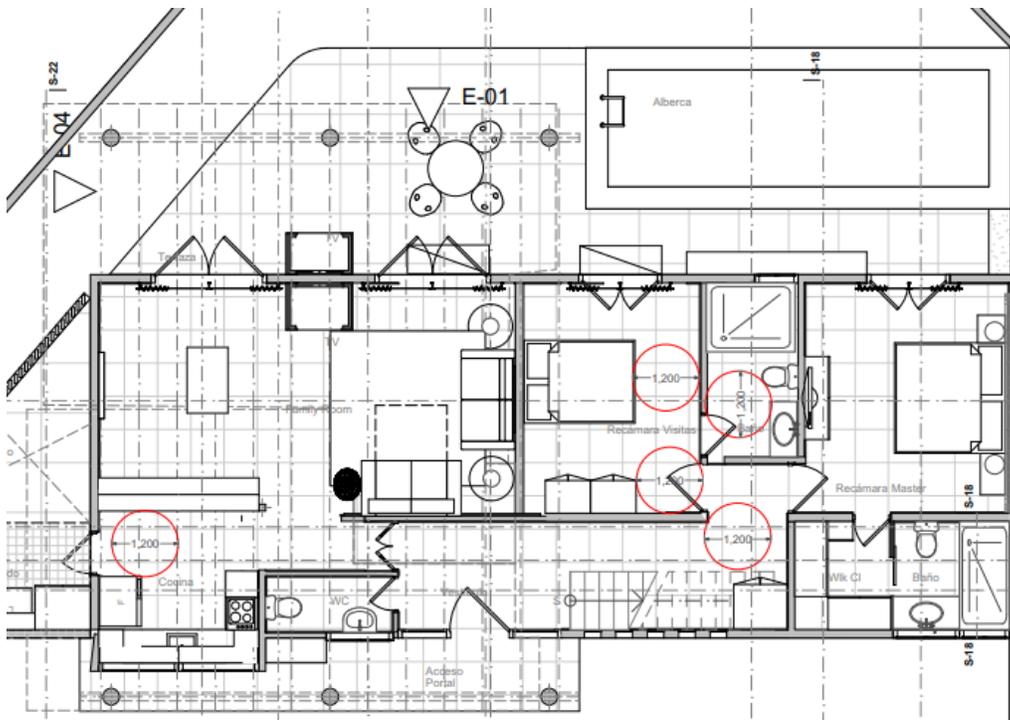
Planta baja: Marcado con círculo rojo las ampliaciones, respetando el radio de giro de 1.20 m
